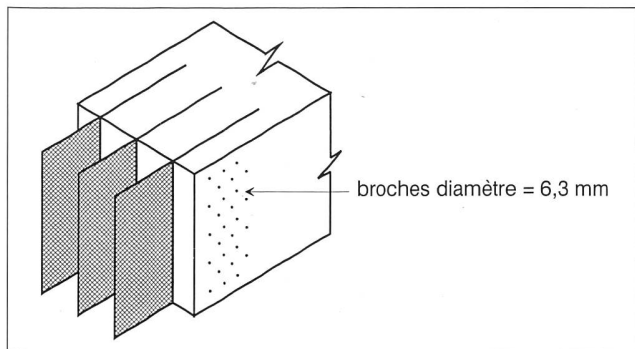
Assemblages brochés métal-bois à plans de cisaillement multiples type BSB.
